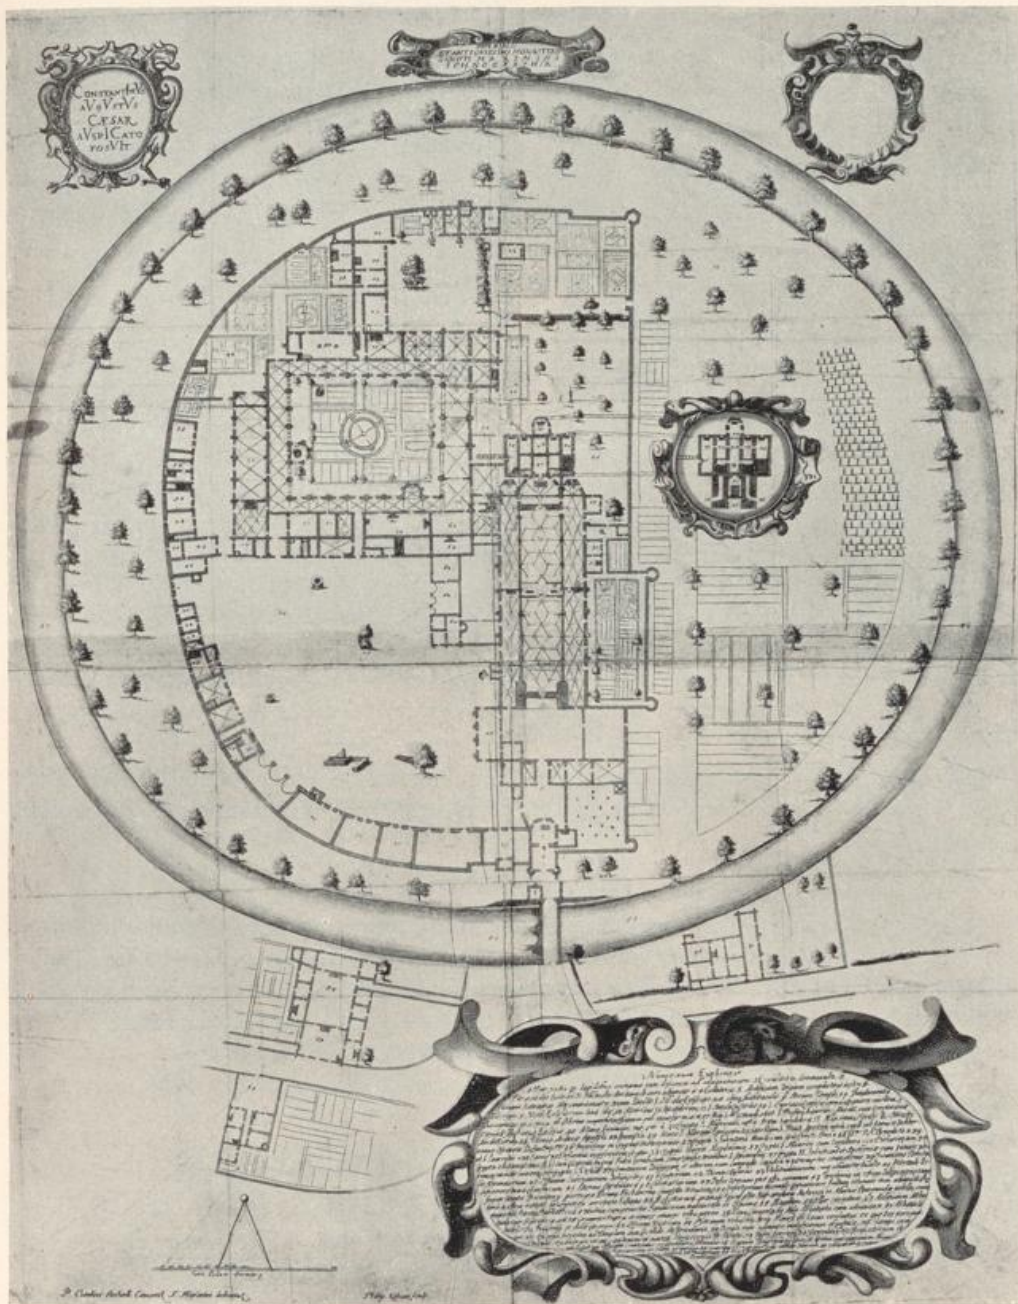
Abtei St. Maximin. Lageplan nach Antony.
